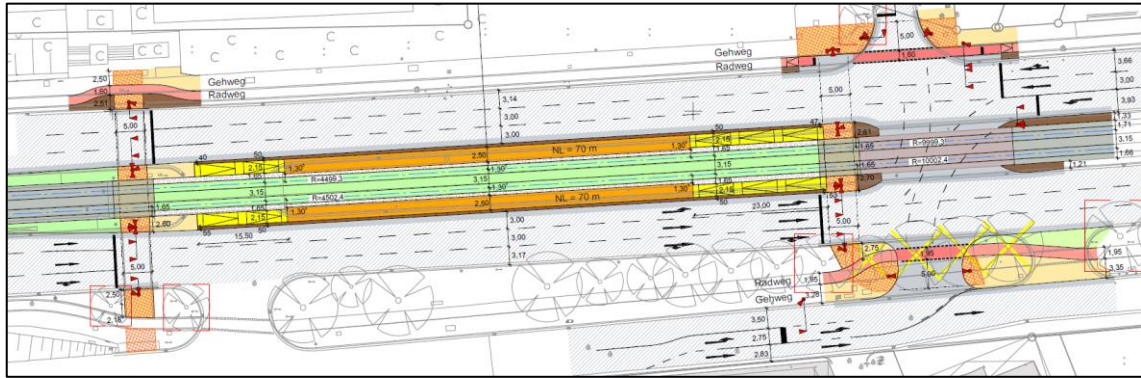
Ausschnitt Lageplan Variante 2b (MBU), V2b_VA0LA1
